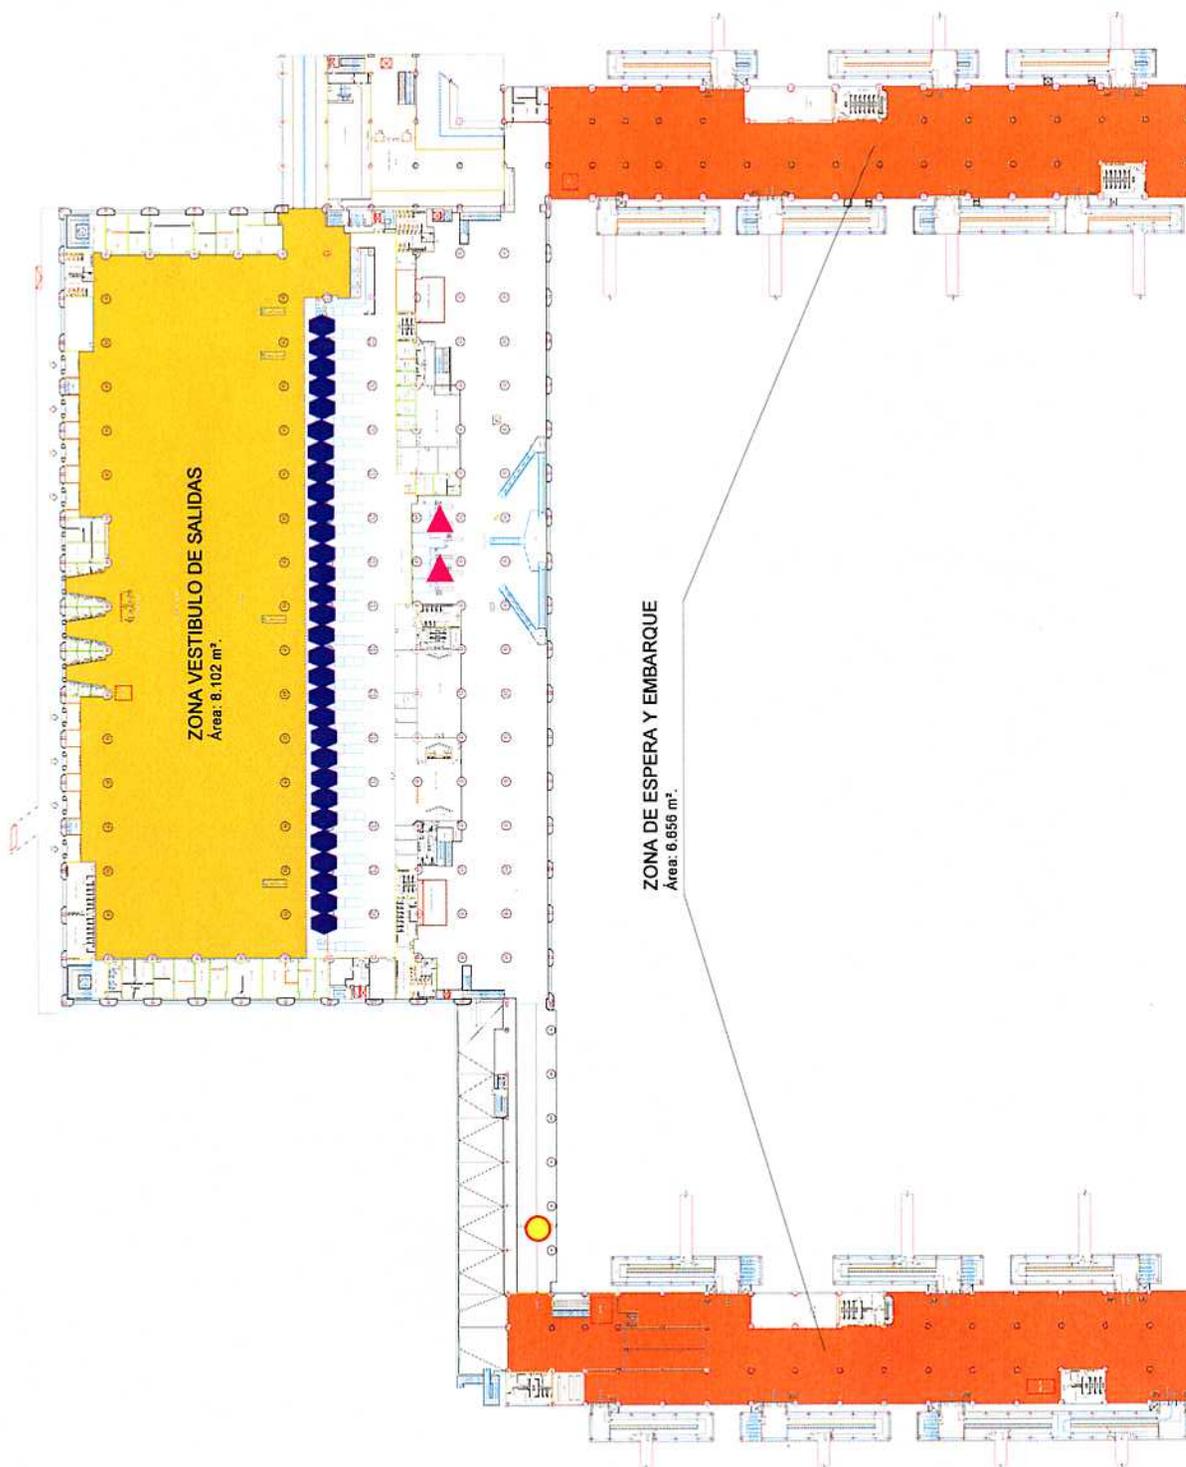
Instalaciones actuales planta baja T2 (2004)
